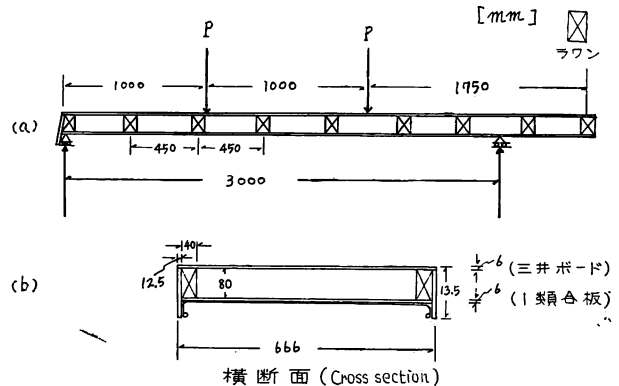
屋根パネルの断面構成、寸法および曲げ試験方法
